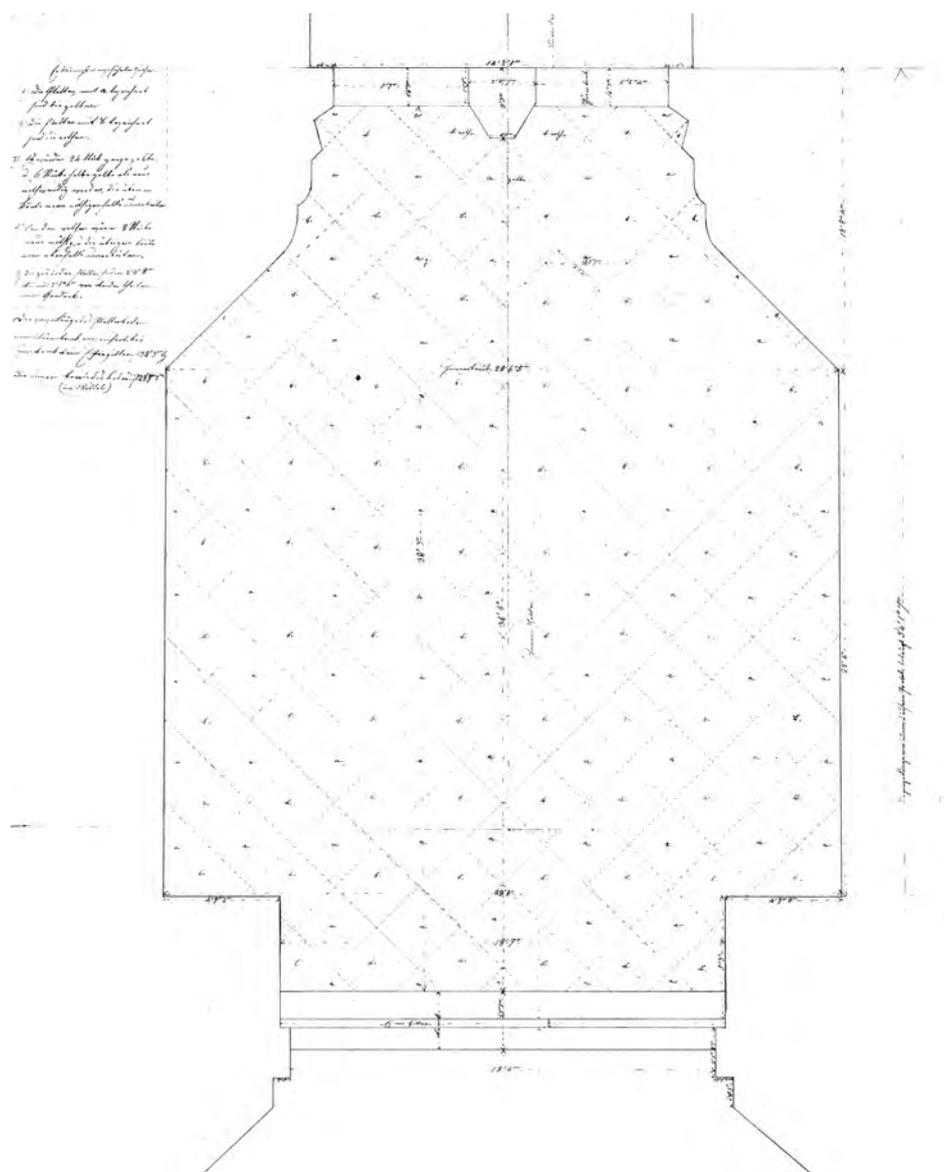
Grundrisszeichnung zur Verlegung der Platten in der Turmvorhalle, Datierung unbekannt, wohl um 1819, Plansammlung des Münsterbauvereins
